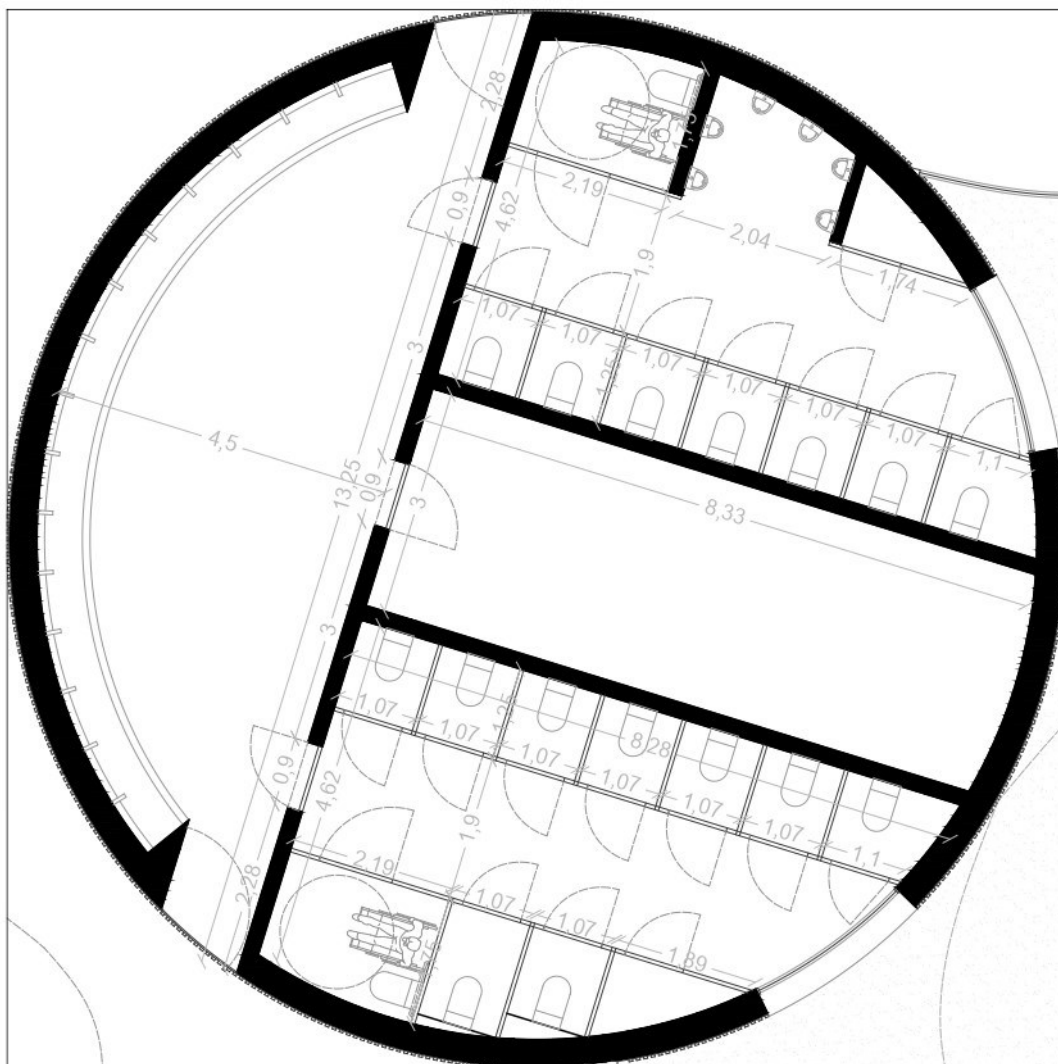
Planta da Instalação Sanitária do Piso Térreo
